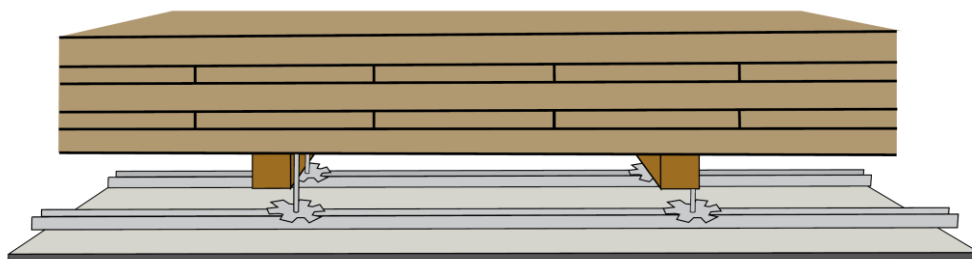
Plancher en panneaux de bois lamellé-croisé avec parement inférieur sans isolation
